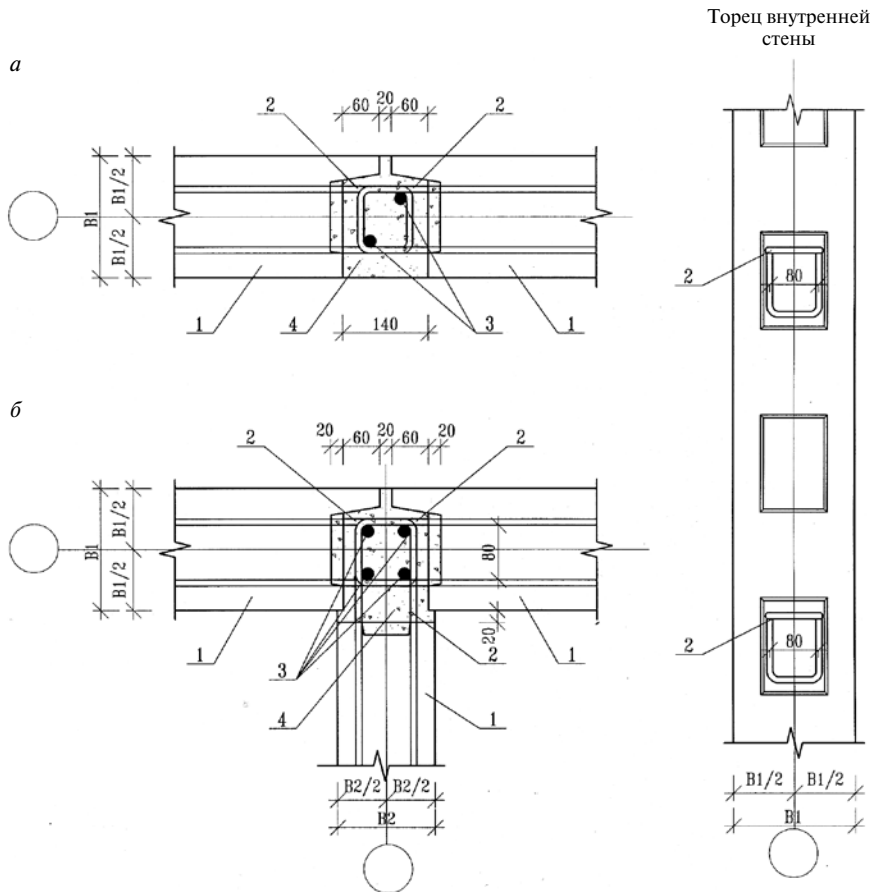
Монтажные узлы внутренних панелей с петлевыми выпусками из обычной арматуры: а – два соединяемых элемента; б – три соединяемых элемента; 1 – внутренняя стеновая панель; 2 – арматурный петлевой выпуск; 3 – арматурные стержни (по расчету); 4 – мелкозернистый бетон кл. В25–В40
